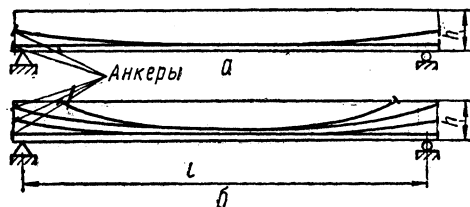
Армирование однопролетных балок стержнями прямыми и криволинейного очертания при передаче сжимающих усилий:
